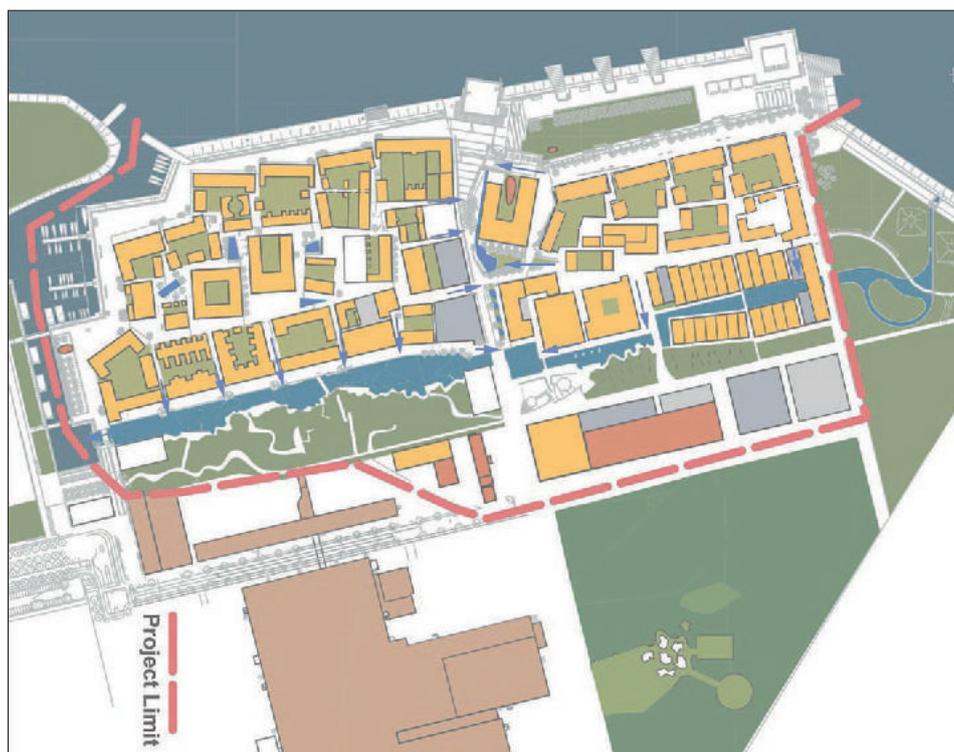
Planimetria (Fonte: Dalman & Von Schèele, 2013)
